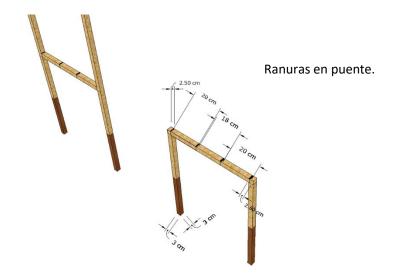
Detalle ranuras de puentes y puentes de escalerillas interiores.
